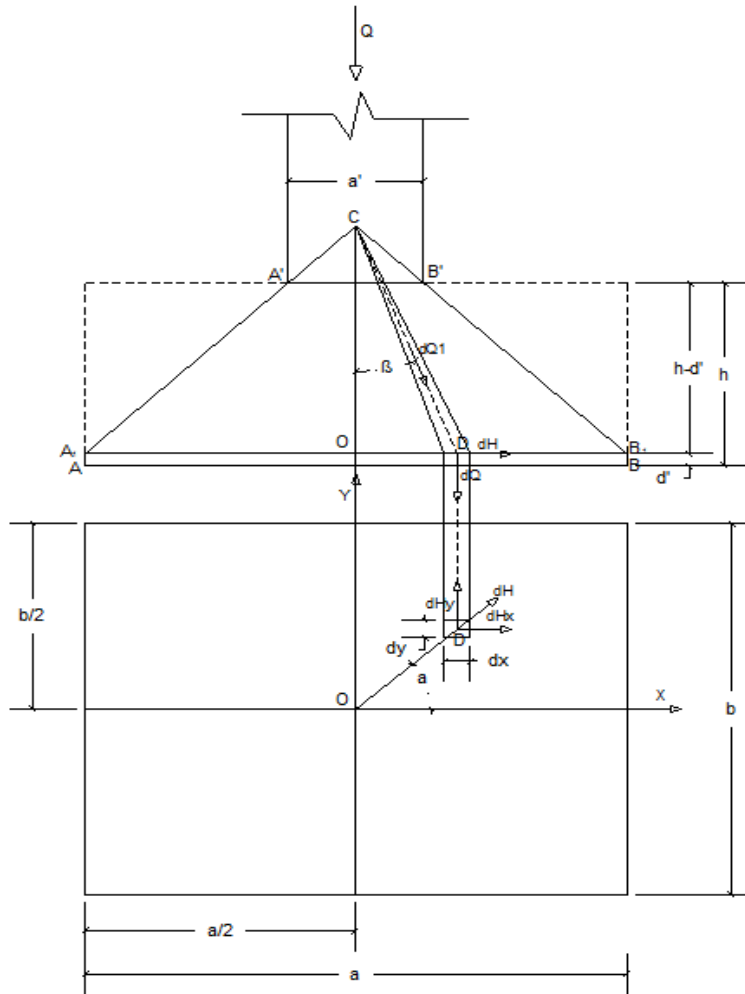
13: Método de las bielas aplicado a columna rectangular sobre fundación rectangular.
